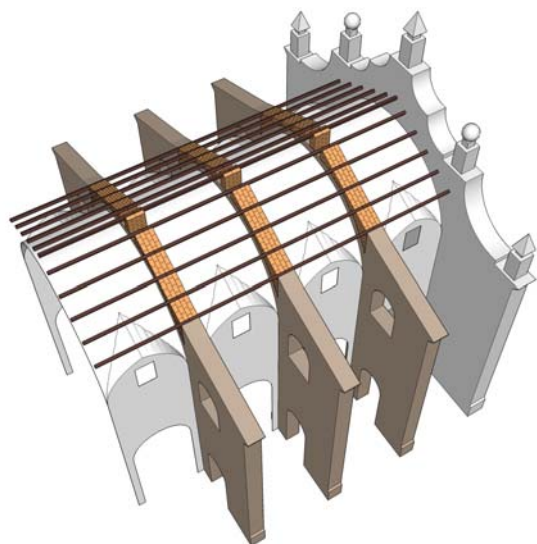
Muretes de la ladrillo y vigas de madera.
